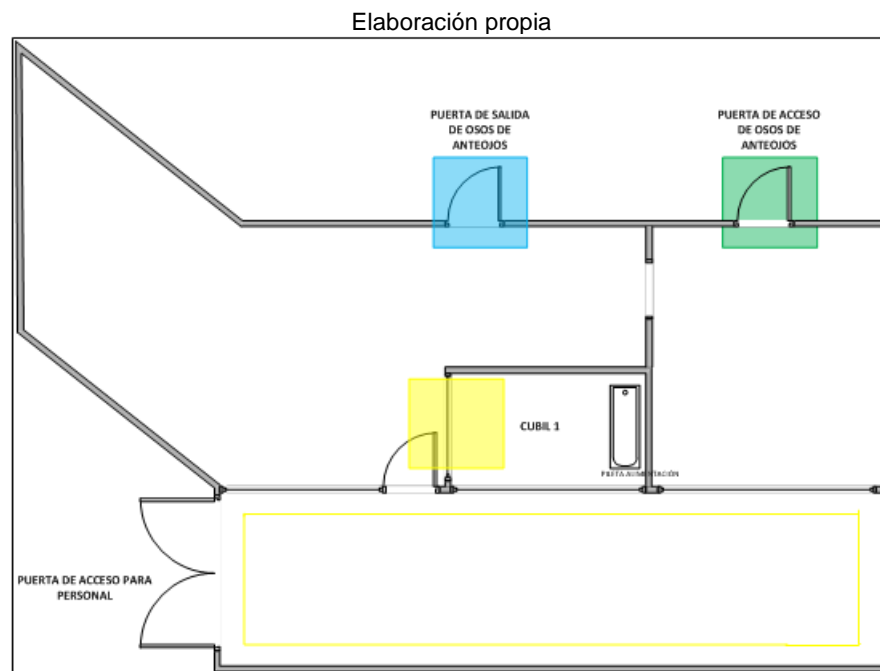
Plano del cubil de los Osos con los colores sugeridos para las guillotinas de las puertas
